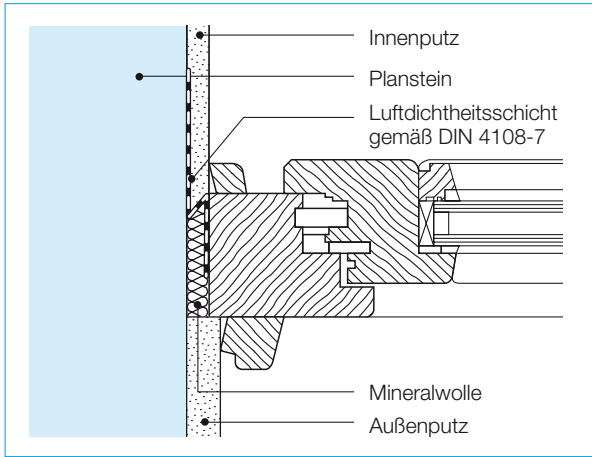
Einschalige Außenwand aus Porenbetonmauerwerk, Fensterlaibung ohne Anschlag
